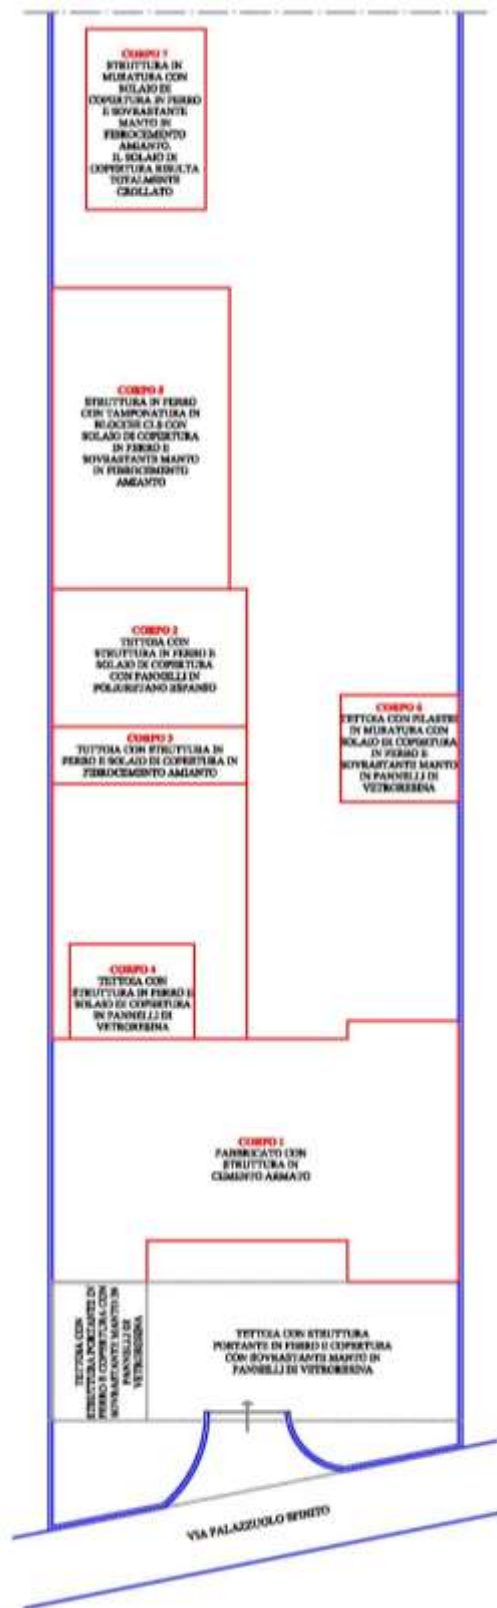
Planimetria generale con indicazione dei manufatti. (all. F)
